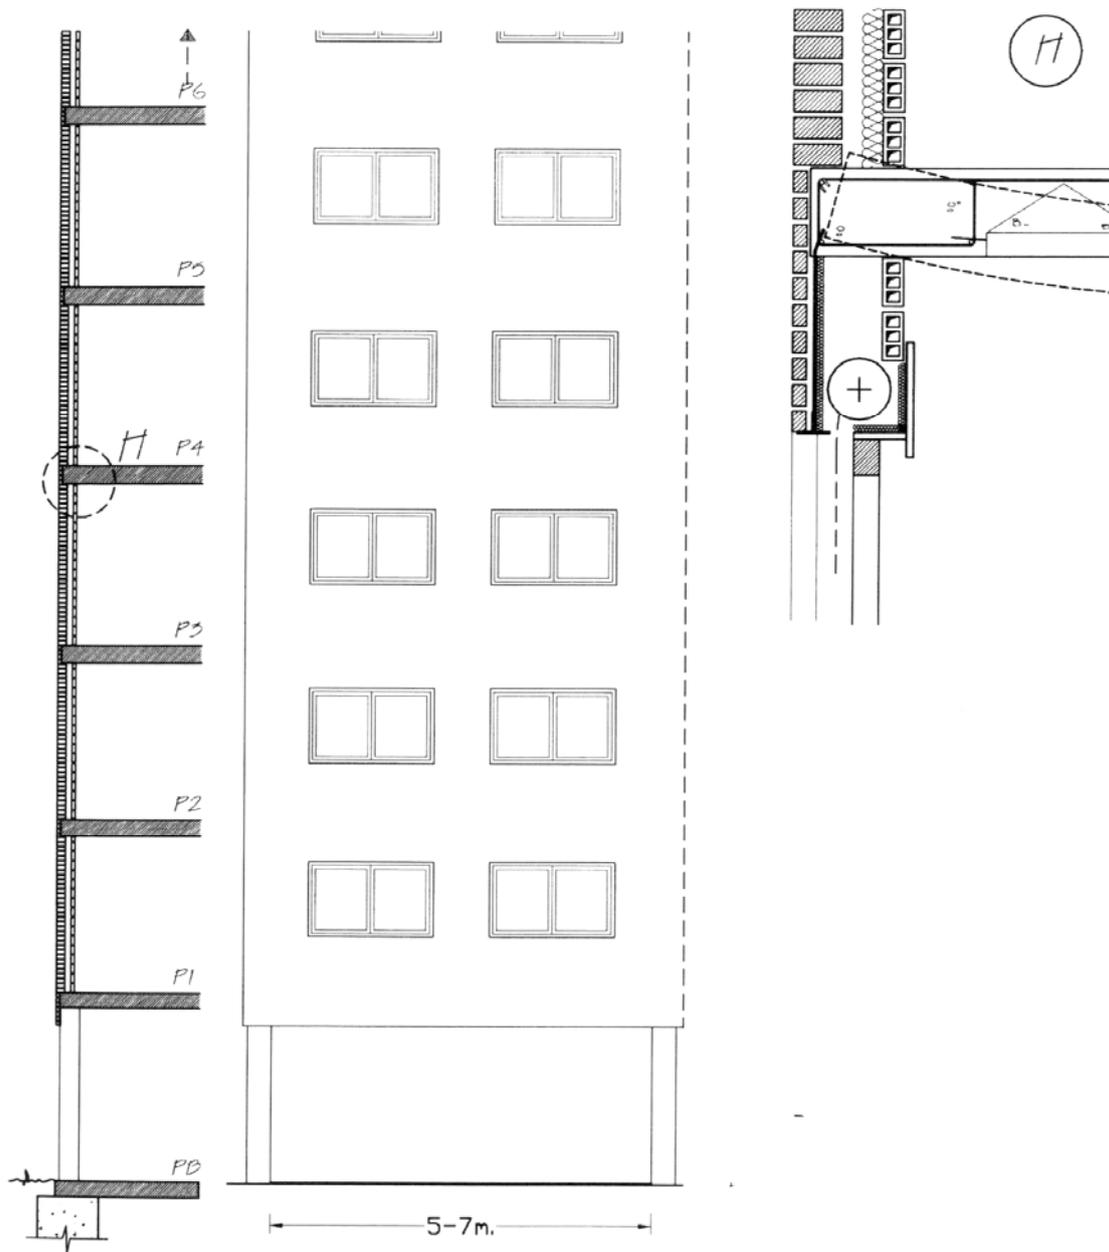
Años 80: Estructura de hormigón armado. Hoja exterior semivolada de $\frac{1}{2}$ pie
